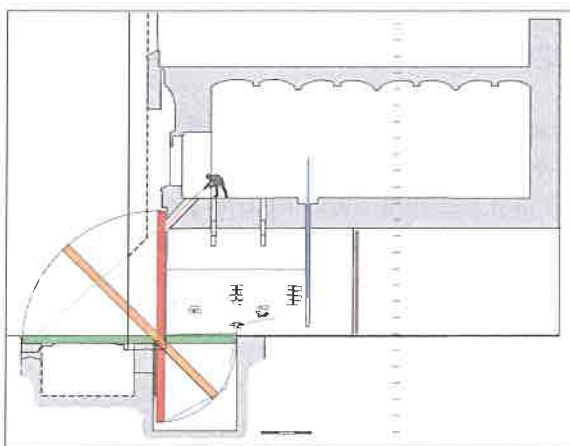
Coupe à travers la porte de Hal (© MRBC).
